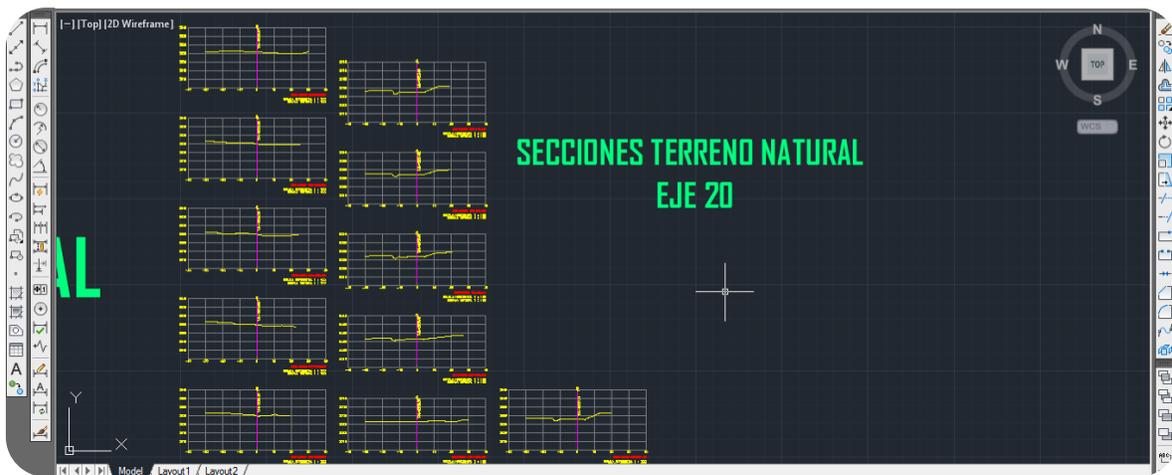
Secciones transversales del terreno natural Eje 20. Fuente: Propia.
